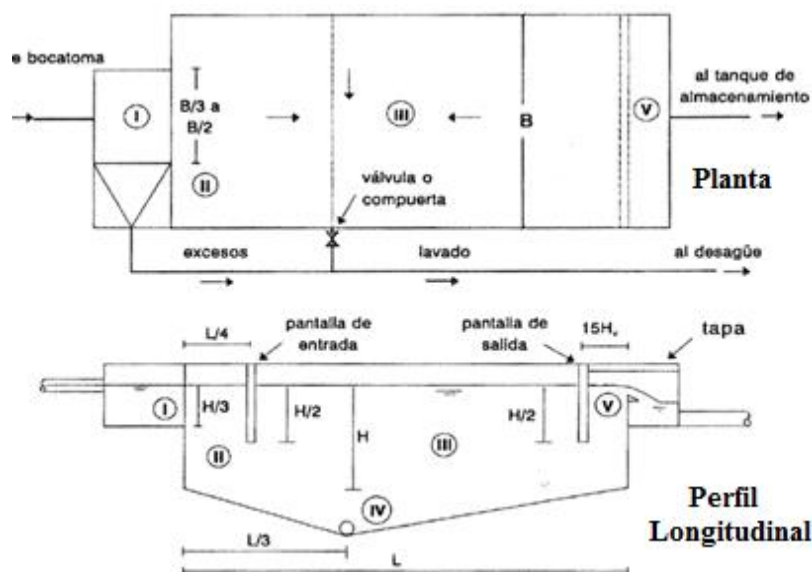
Desarenador vista en planta y perfil longitudinal.
